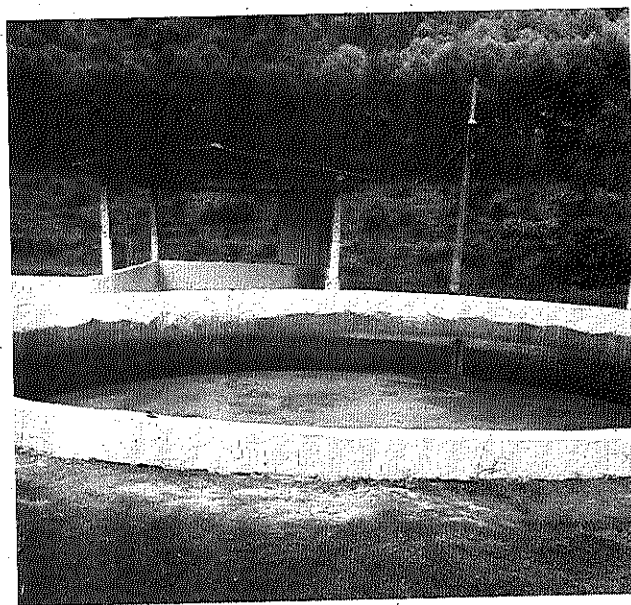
Caixa de recebimento dos efluentes que são utilizados em um sistema de fertirrigação.
